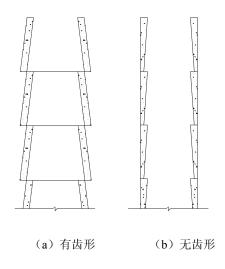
人工挖孔大直径灌注桩护壁构造
